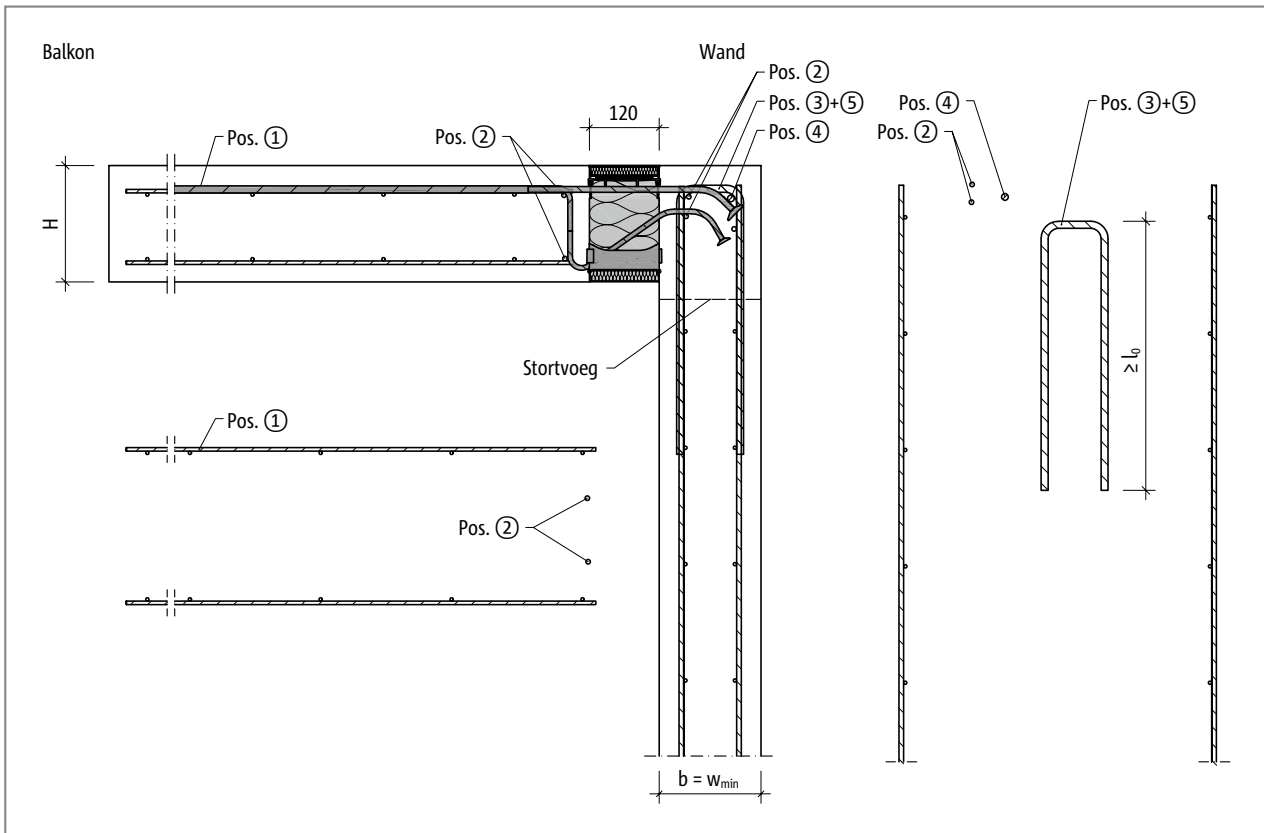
Schöck Isokorb® XT type K-O: bijlegwapening voor hoger gelegen balkon aan bouwdeel met grotere afmeting ($w_{vorb} > w_{min}$)
